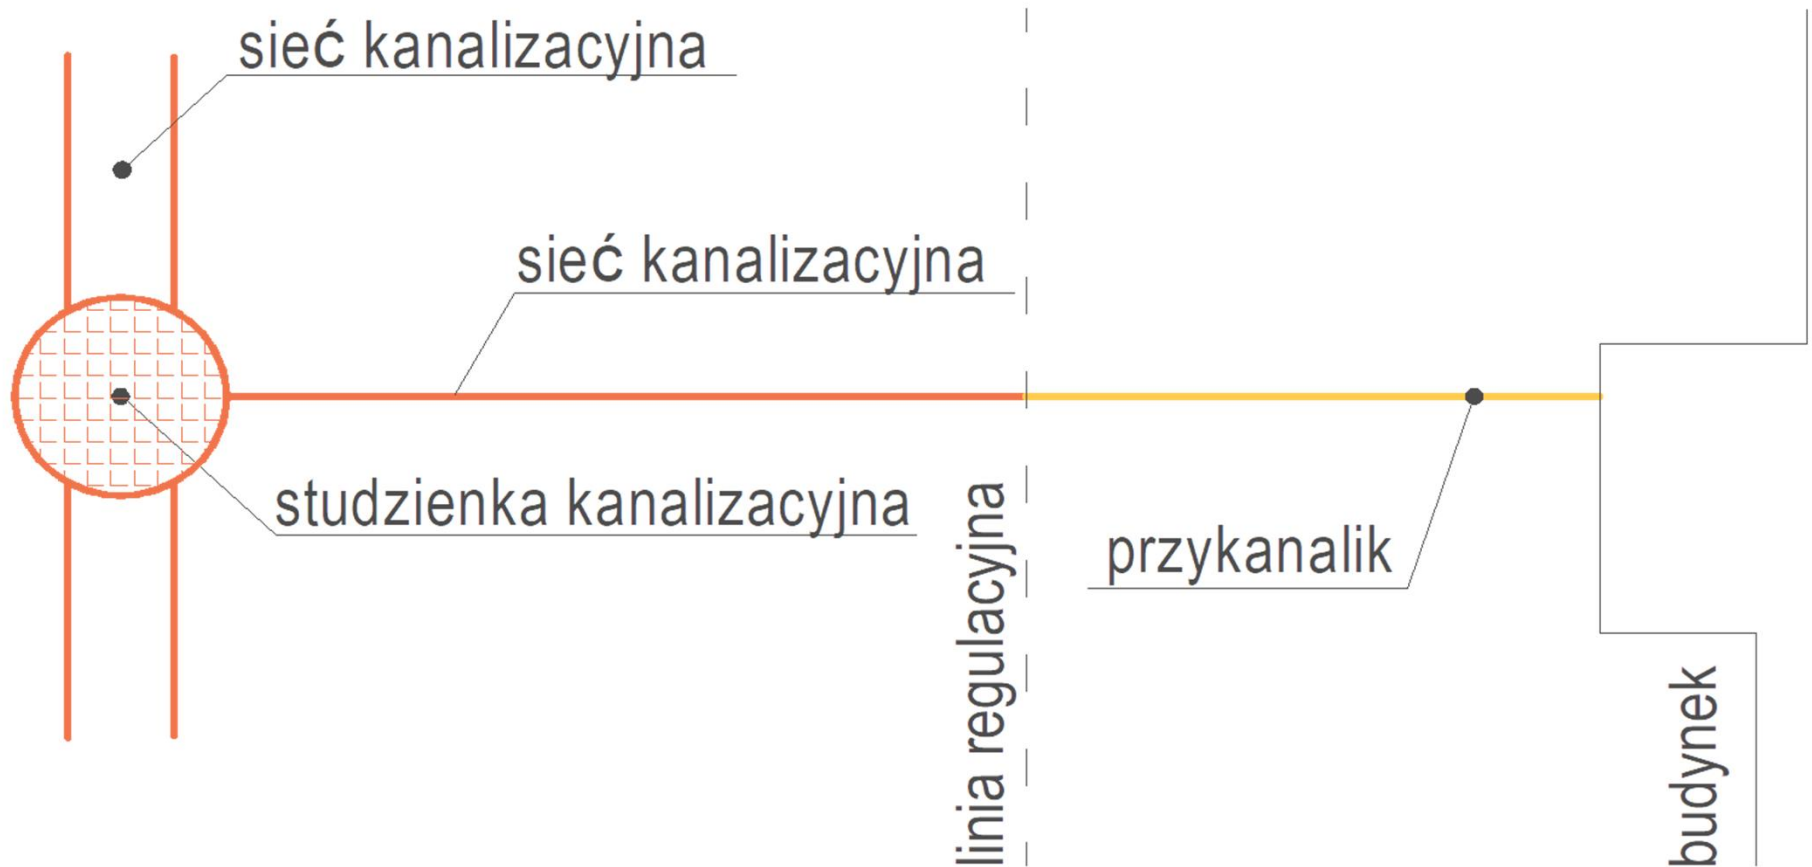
Rzut przykanalika instalacji kanalizacyjnej wyposażonego w studnię rewizyjną
